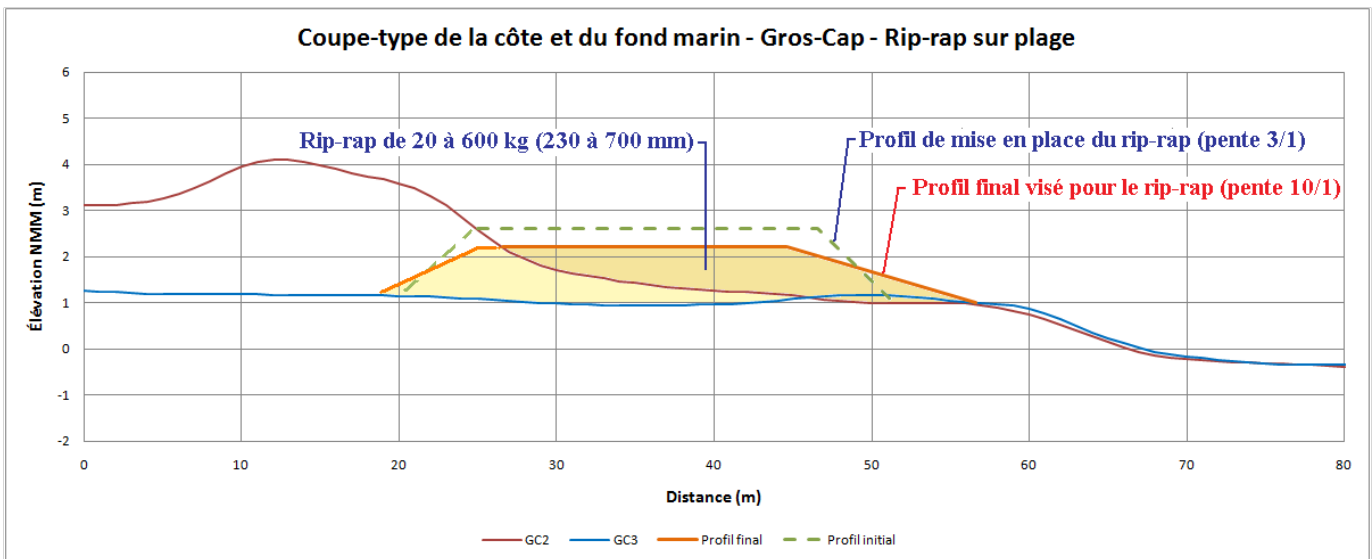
Coupe type d'une protection de berge en matériaux grossiers sur la plage de Gros-Cap
